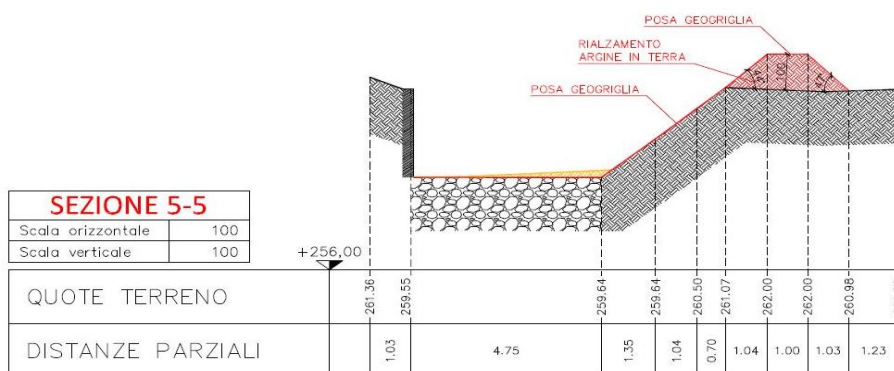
PARTICOLARE DI PROGETTO DEL PRESIDIO ARGINALE E ADEGUAMENTO DELLA SEZIONE DI DEFLUSSO IN COMUNE DI TORRE DE ROVERI ALL'ALTEZZA DELLE CASE ALER
